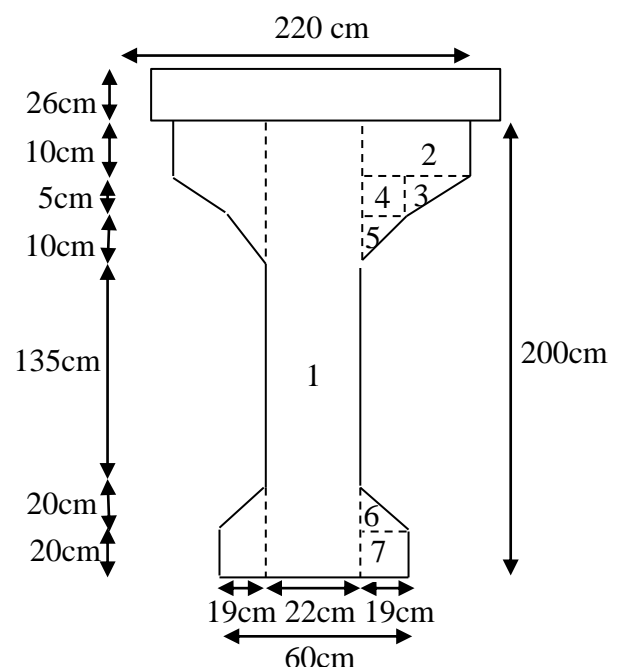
Section médiane de la poutre de rive avec hourdis.
